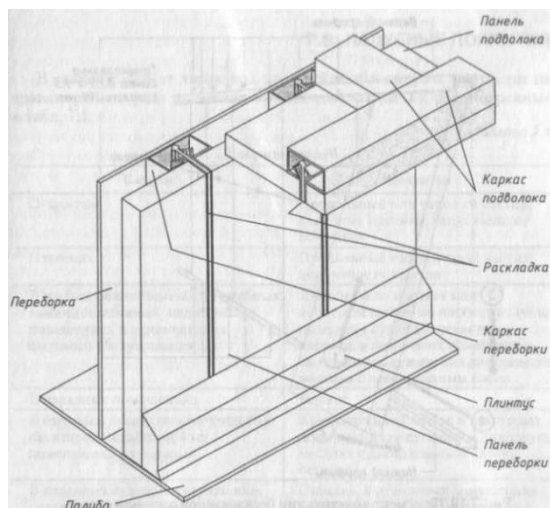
Фрагмент каркасной конструкции обстройки судового помещения.
